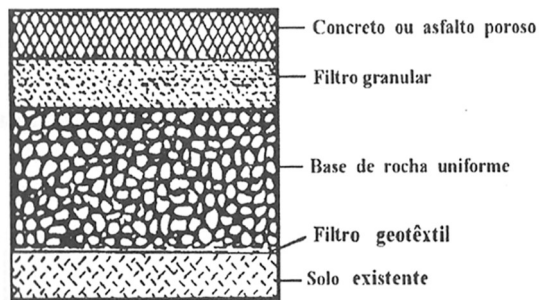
Pavimento poroso (Urbonas e Stahre, 1993)
